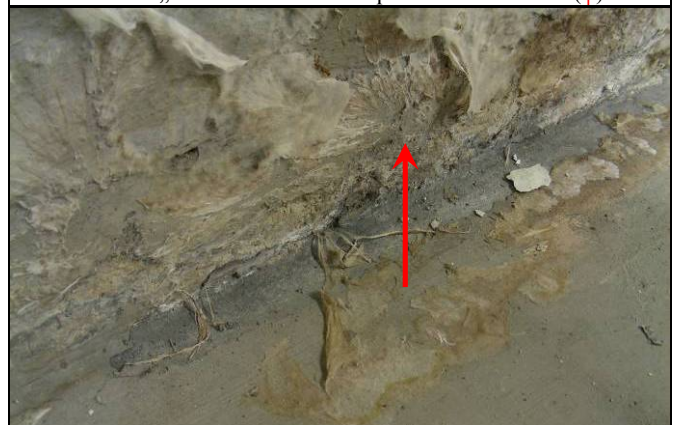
Graue Stränge des Wilden Hausschwammes wachsen am Mauerwerk und durchwachsen es (↑); das Mycel wuchs hier hinter Unrat in einem Kellerraum mit Betondecke. Nahrungsgrundlage waren Fenster-Teile und eine „verlorene“ Holzschalung.
